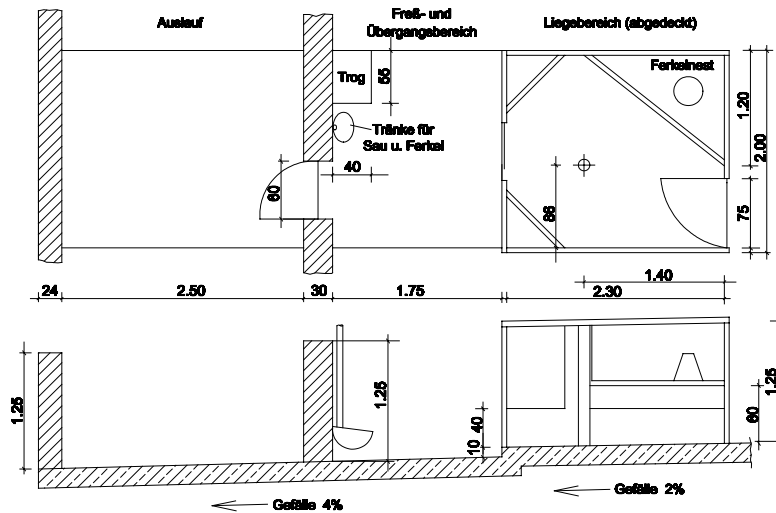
Grundriss und Schnitt der „Schweizer-Bucht“ (LfL - ILT, überarbeitet)
